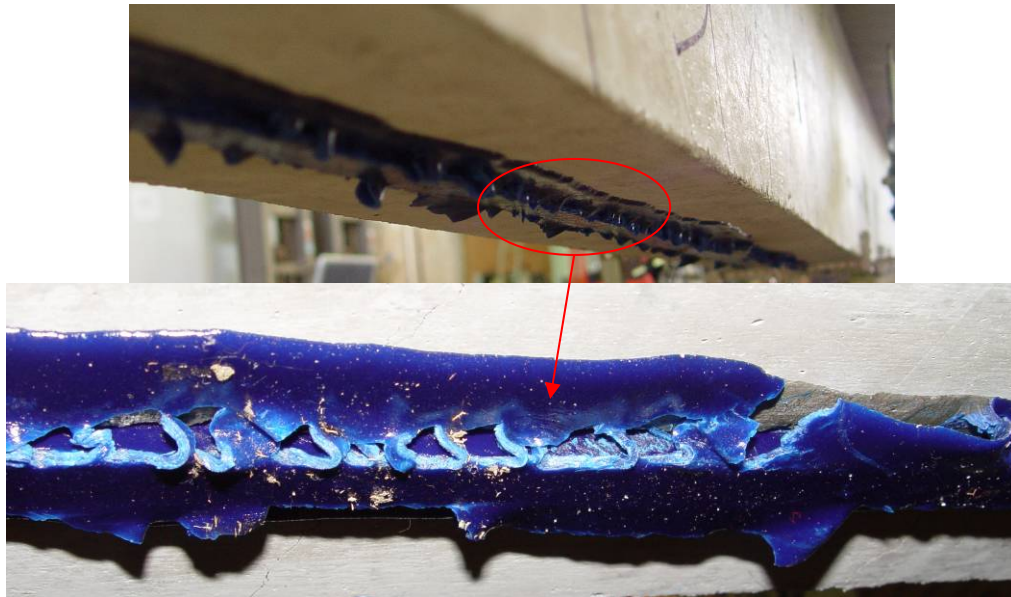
Detalhe do escorregamento da resina da barra de aço na viga VA – RBA durante o ensaio
